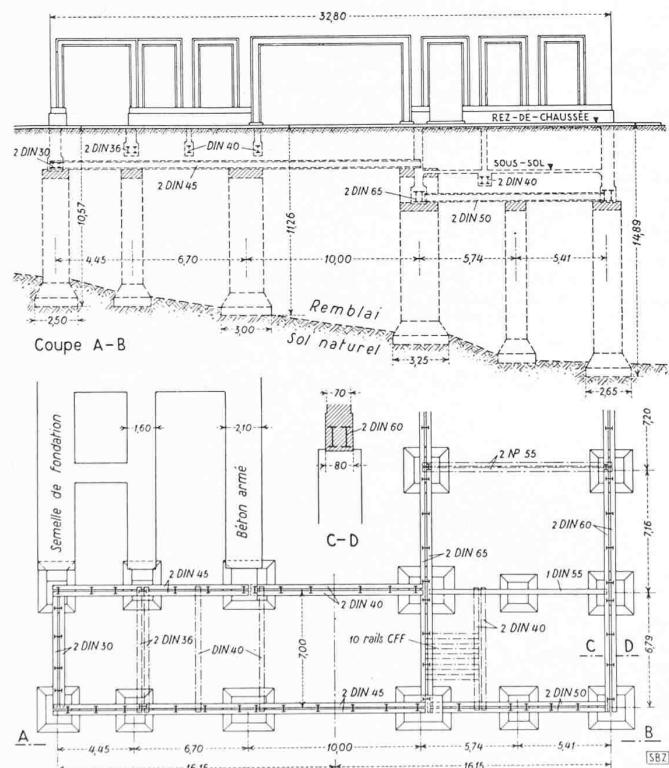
Fondation du Bâtiment principal, côté Ouest. — 1 : 400
